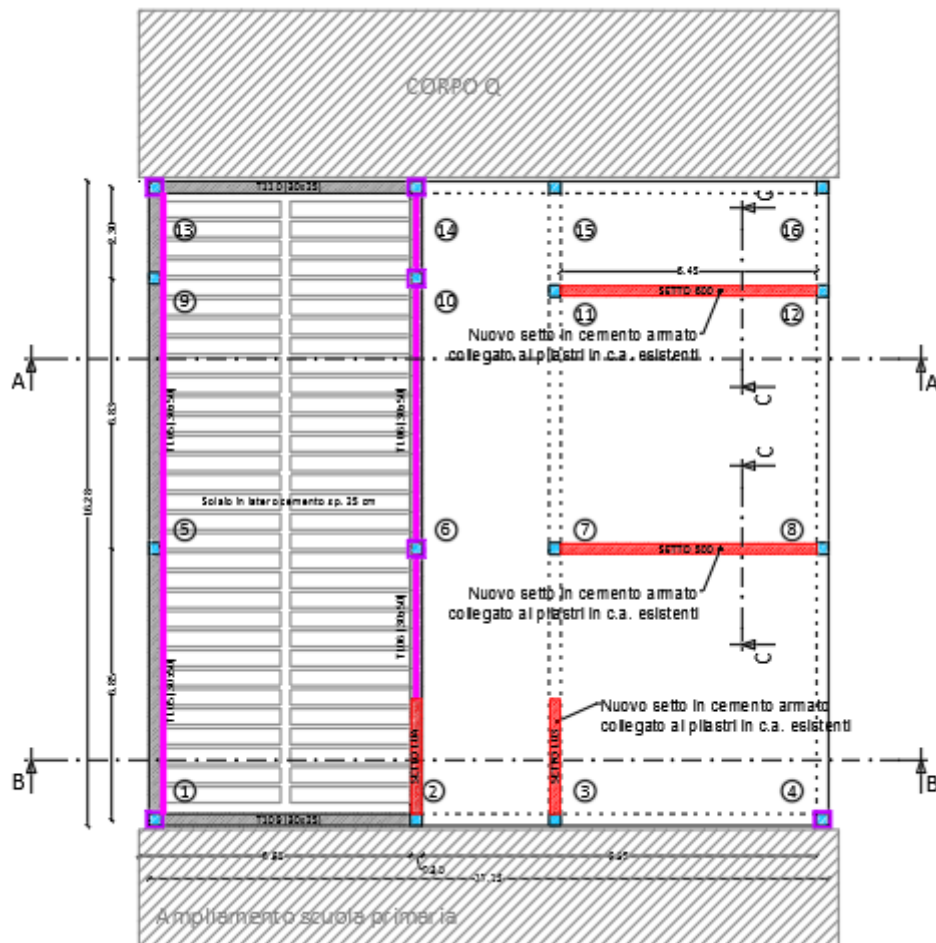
Planimetria Pianta Soppalco corpo 4 aule – in magenta incamiciatura pilastri.
